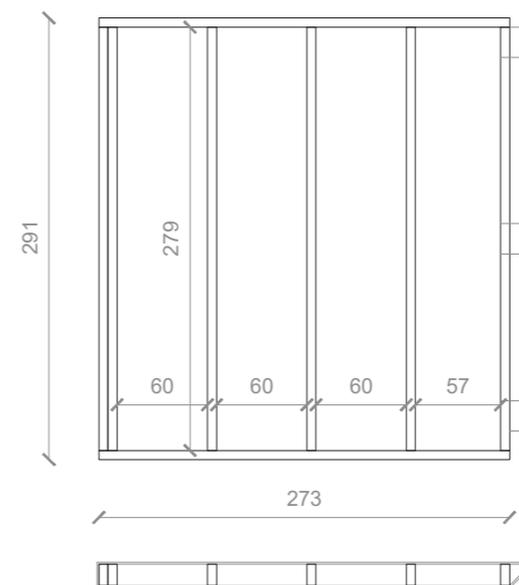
Prospetto quotato chiusura verticale prefabbricata 05A
